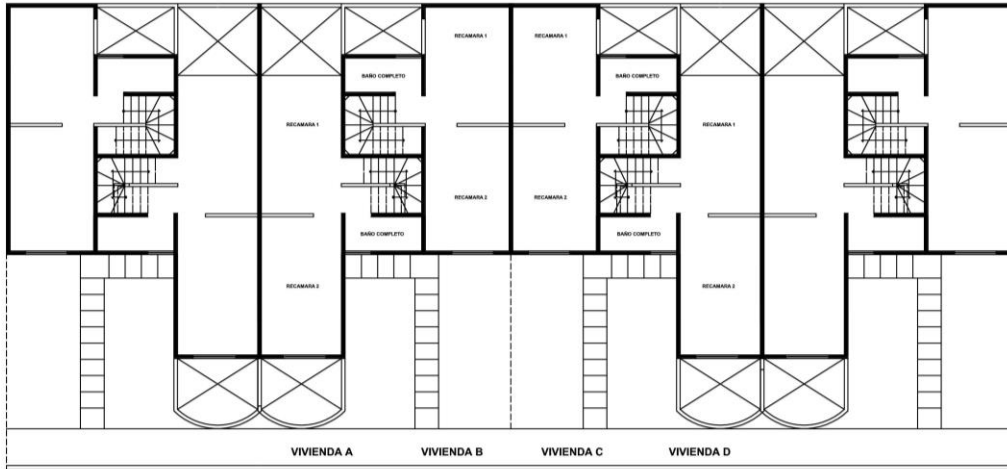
Planta Arquitectónica Vivienda Horizontal Tipo B, Fuente: (Autoría propia, 2019)
